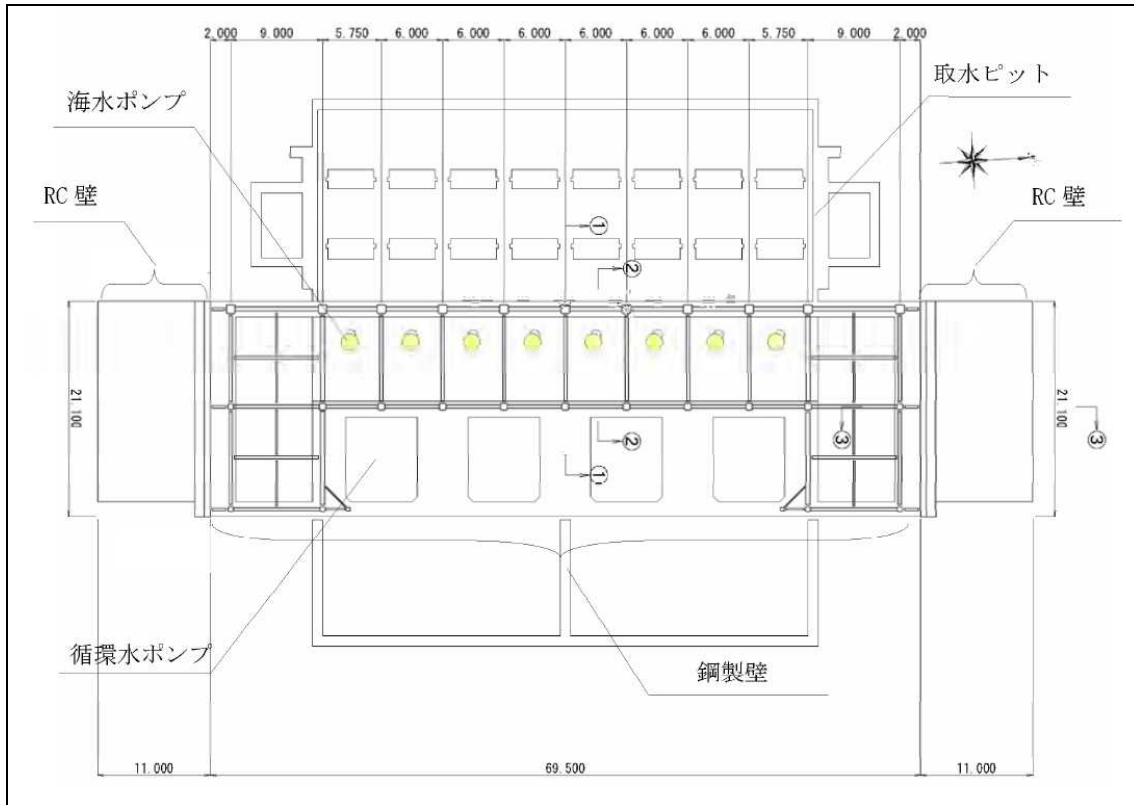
海水ポンプエリア防護壁の平面図 (九州電力 川内 1, 2 号炉)
